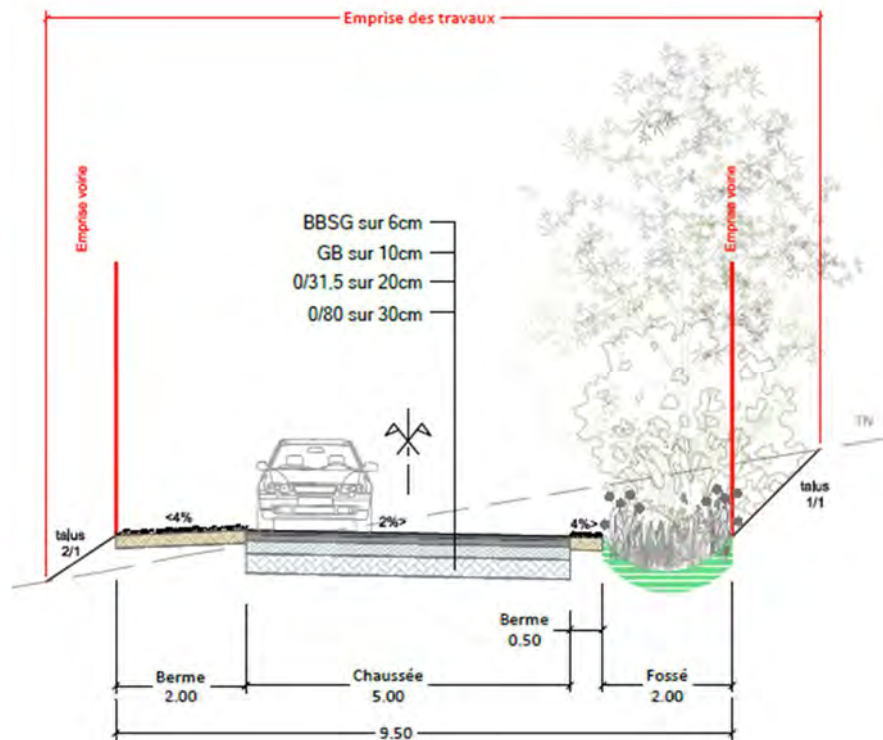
Profil en travers type de la voie F (Source: Atelier LD)
